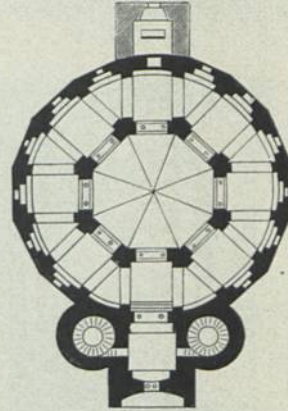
Grundriss des Münsters zu Aachen
